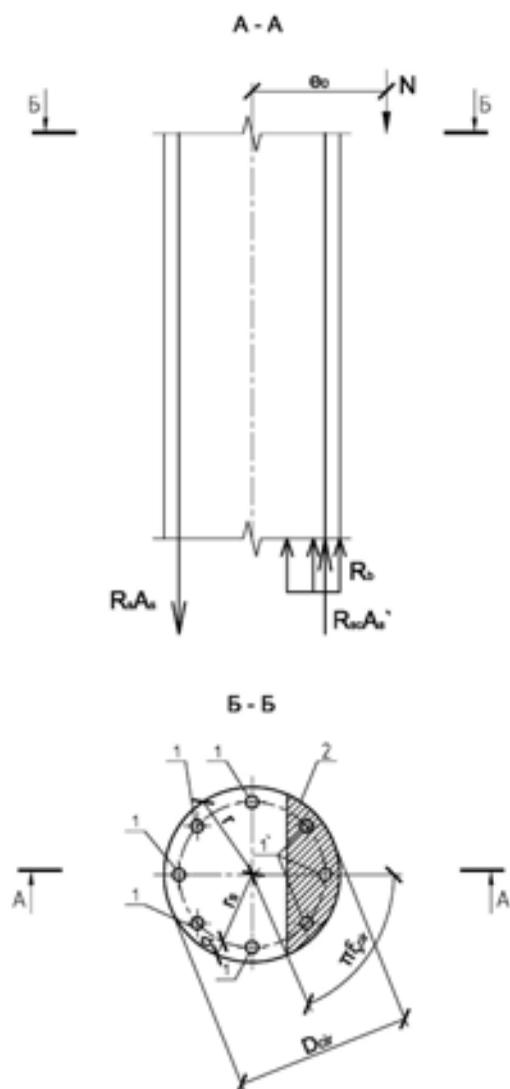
Схема расчета требуемой площади продольной арматуры колонны круглого сечения:
